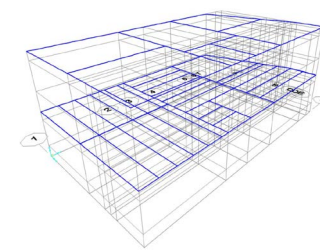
Elementos que conforman las vigas de entepiso y cubierta de la edificación de VAP.
